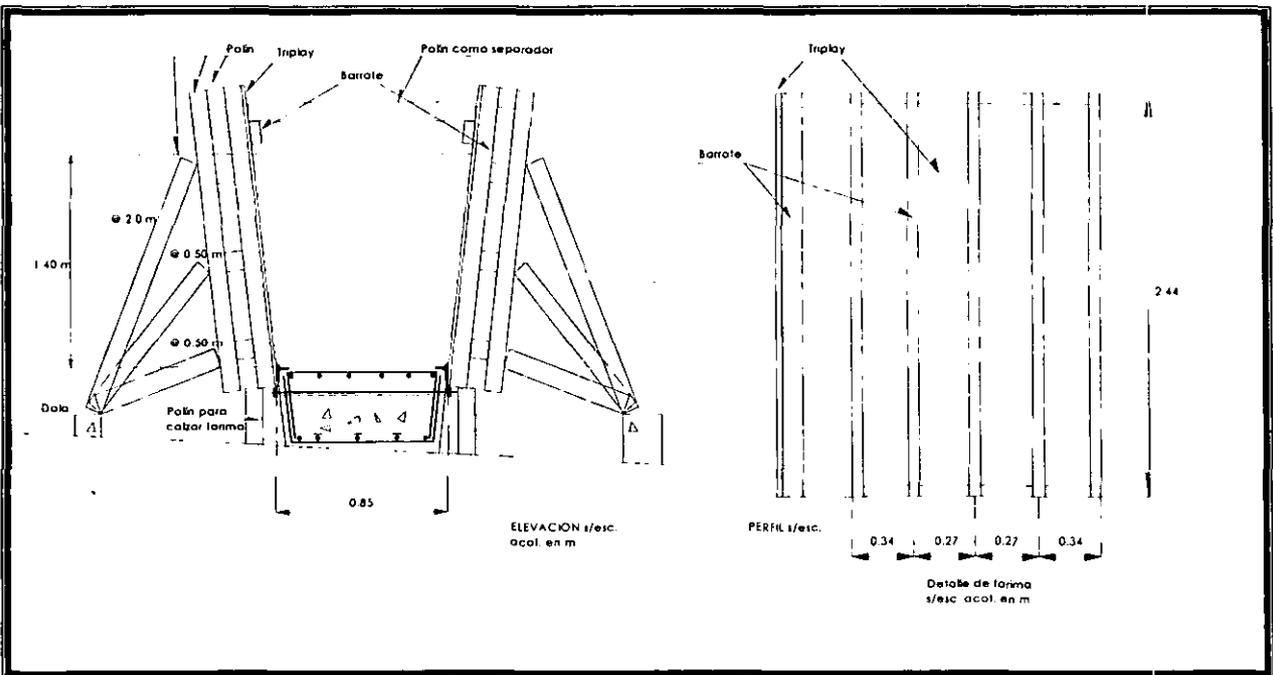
Cimbra de madera para trabes de prefuerzo.
